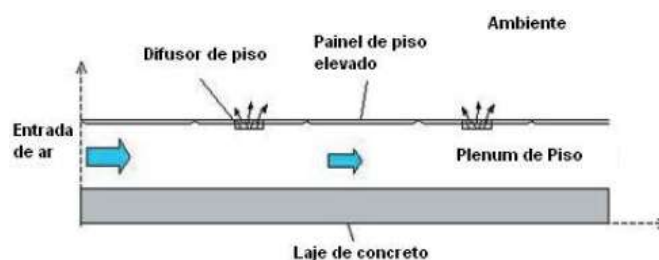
Esquema de um pleno existente no pavimento (Leite, 2003)
